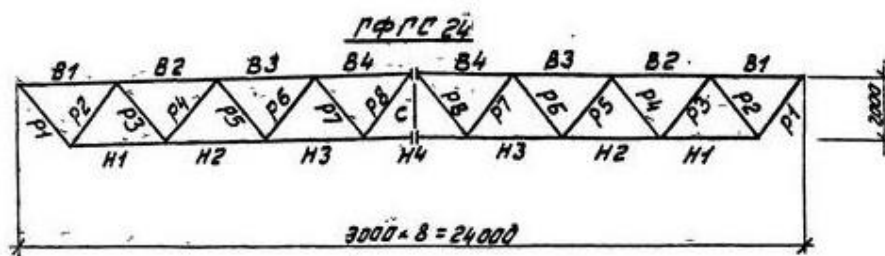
Геометрическая схема фермы по серии 1.263.2-4
